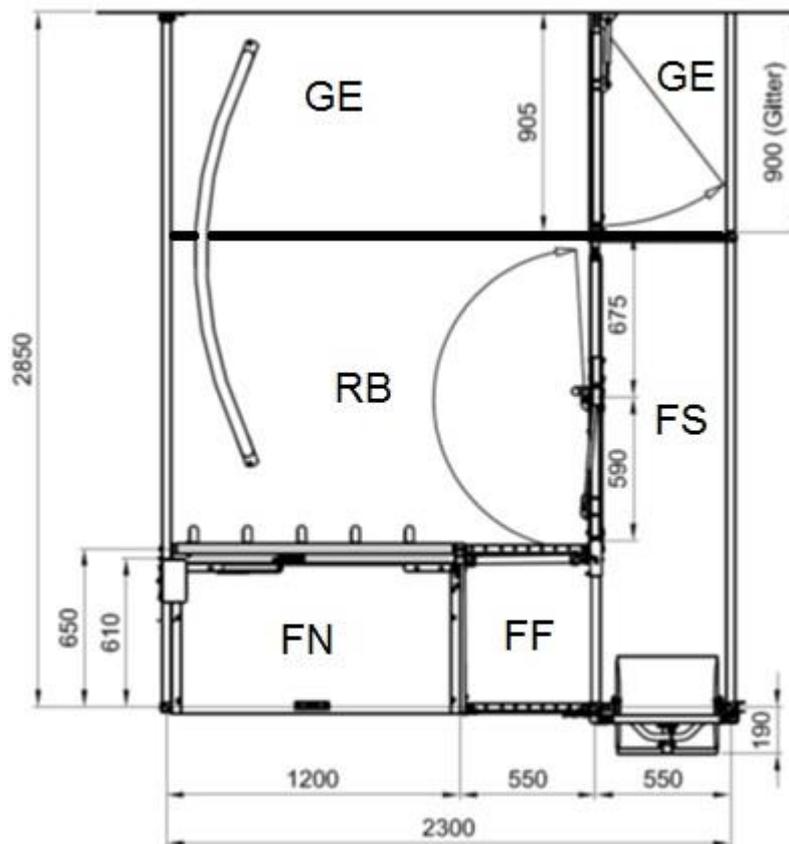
Buchtsskizze der WelCon-Bucht mit Maßen
